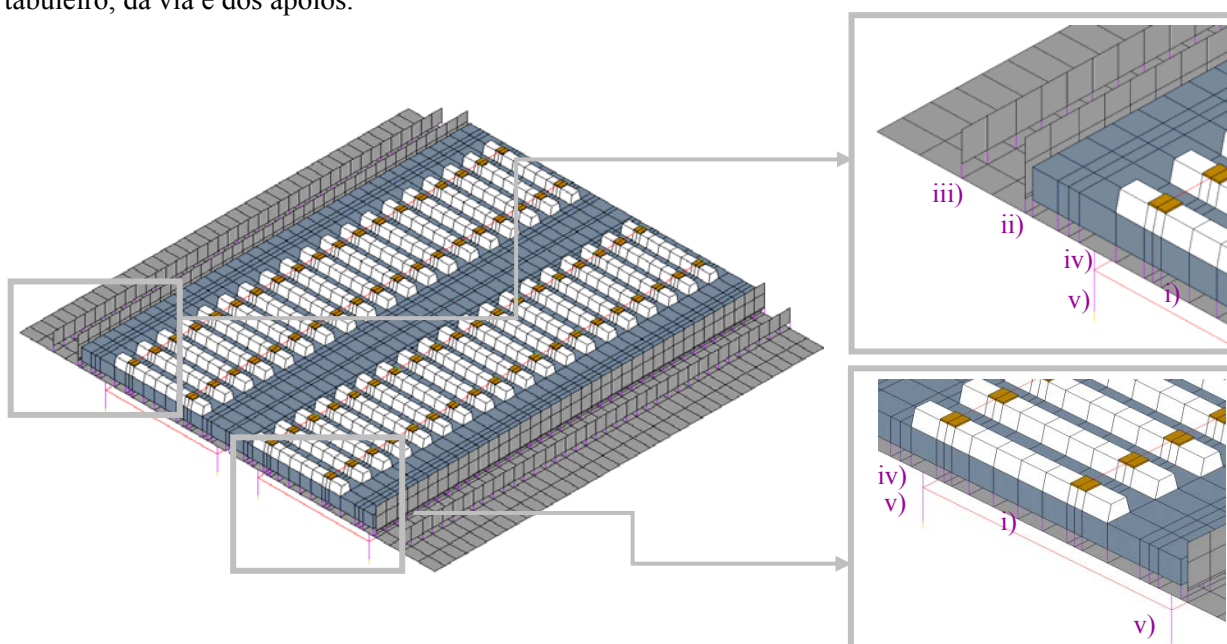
Modelação da ligação entre elementos por intermédio de elementos finitos de viga rígida (MPC184).
